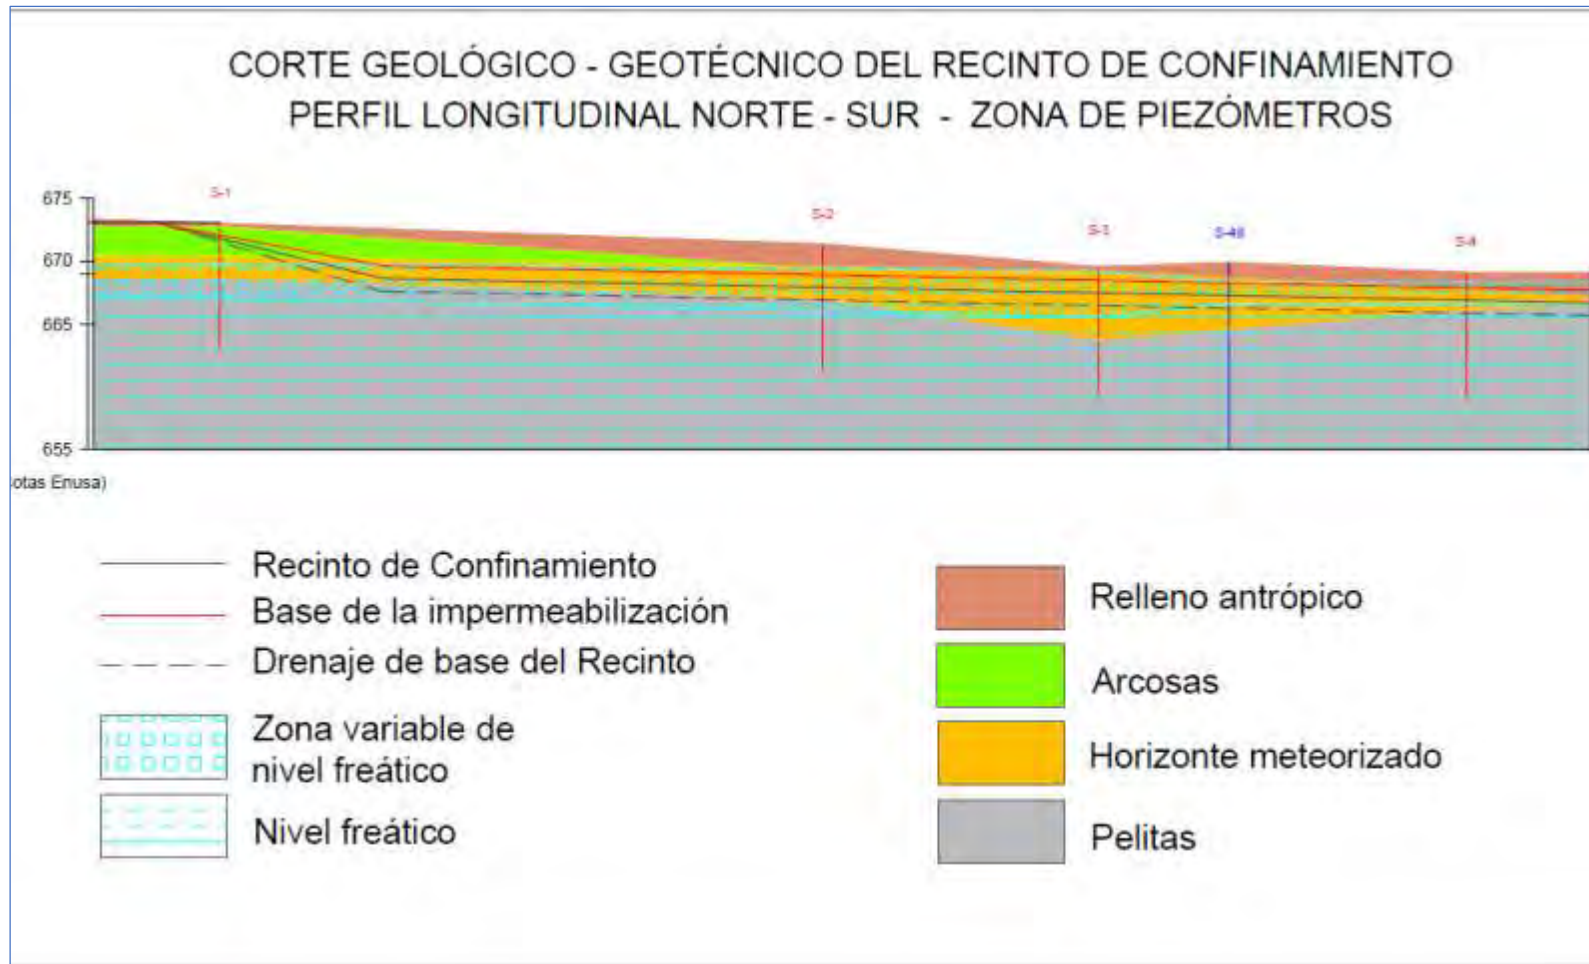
Perfil norte-sur, zona de piezómetros, Recinto de Confinamiento. Corte geológico - Geotécnico y nivel freático
